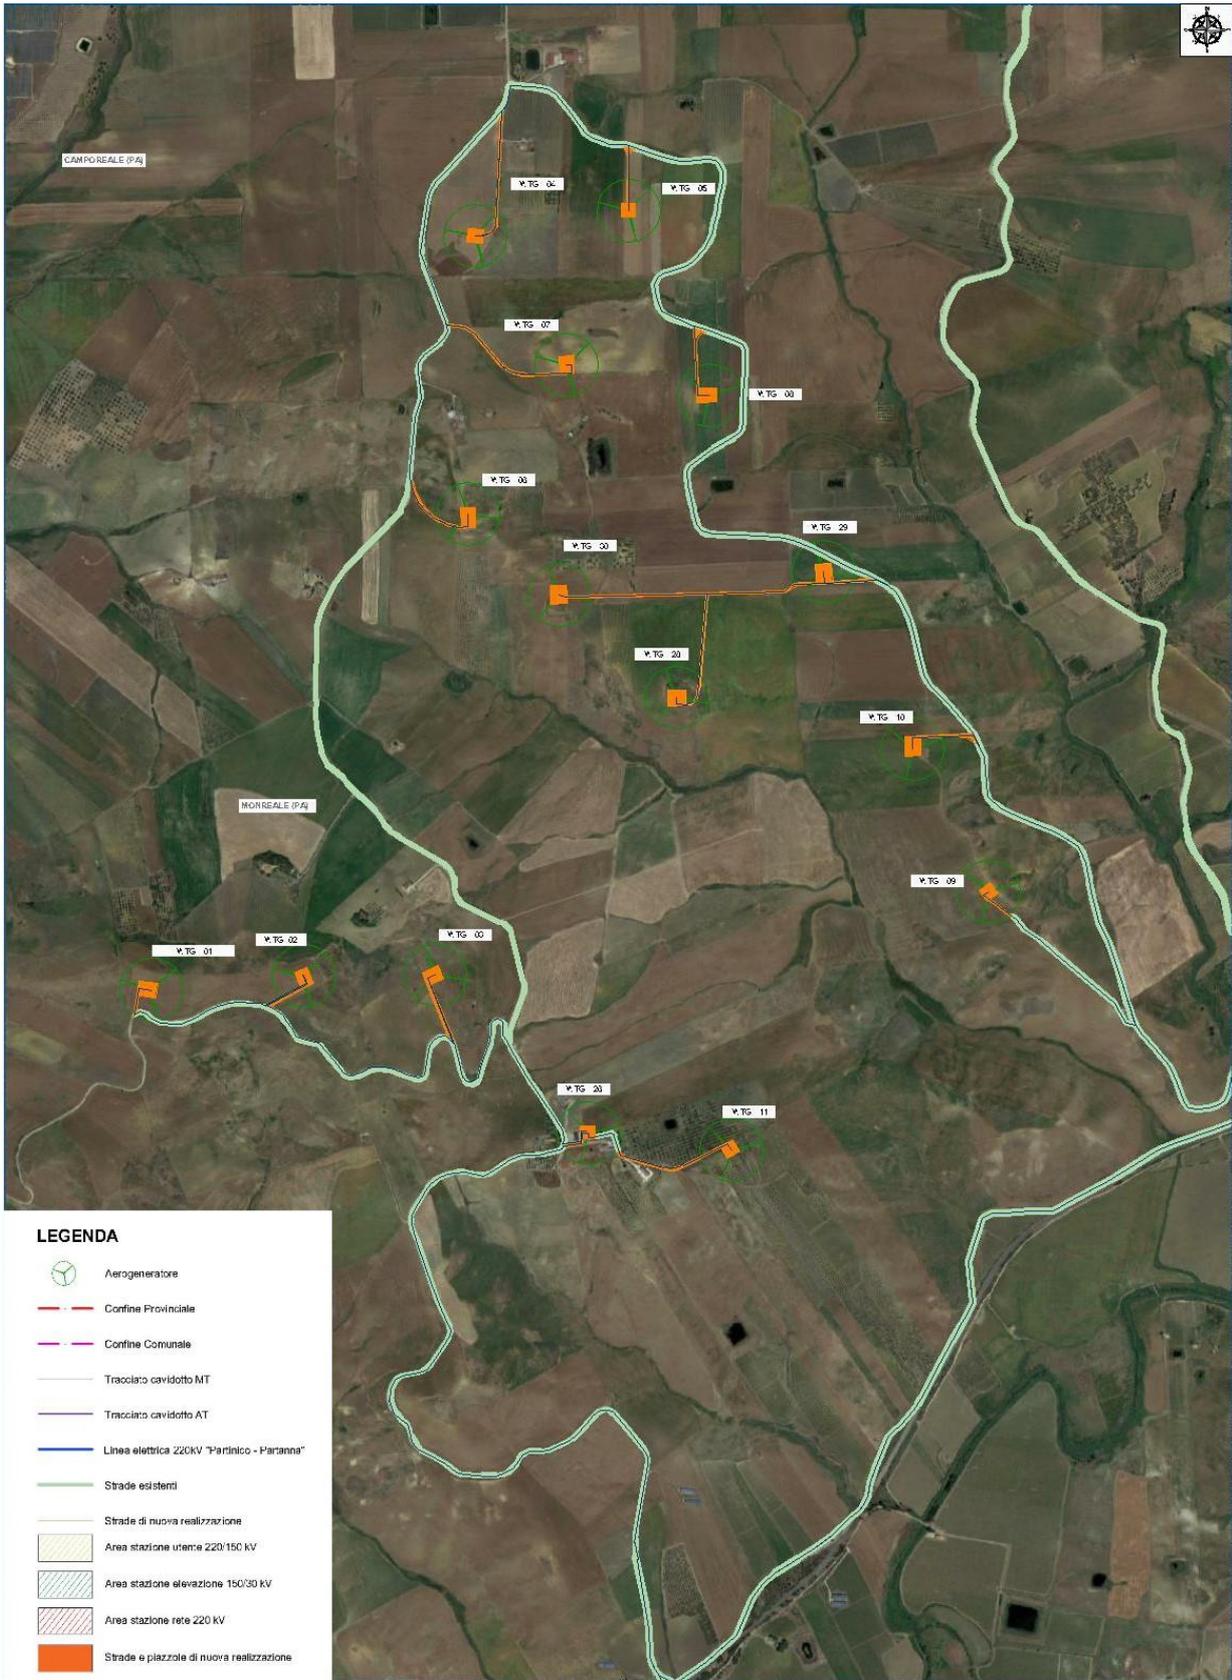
Ortofoto dell'area di impianto ricadente in Contrada Parrino e Pitarre
